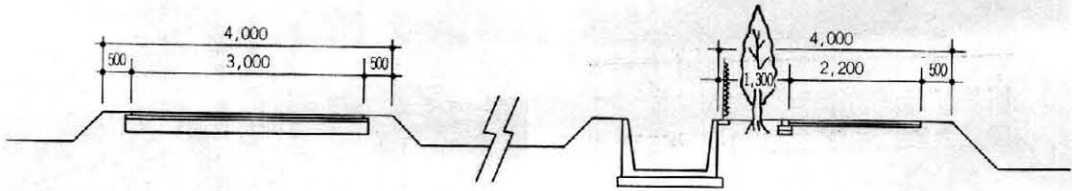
幅員が狭く歩車道分離が出来ないが隣接する用水路沿いの道路を自転車道として 写真-11 整備出来る場合は緑道とする。
